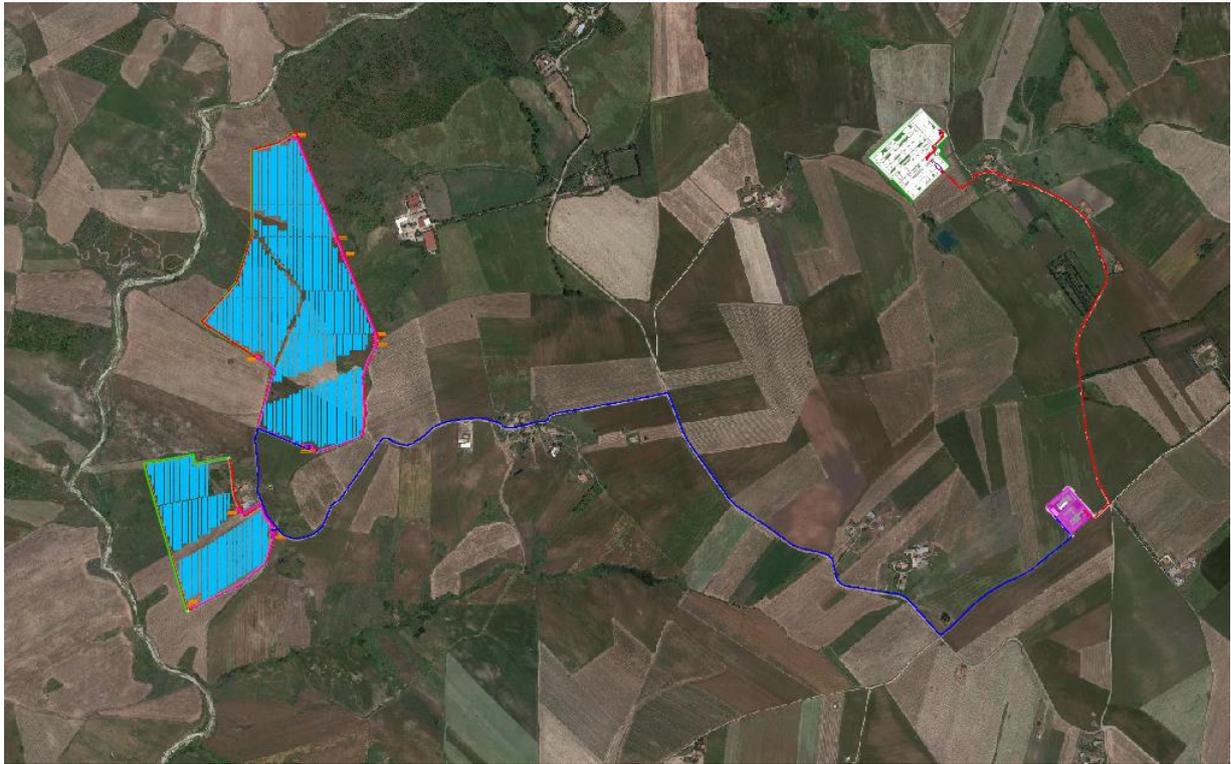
Stralcio elaborato DEF-TAV.04 – Layout su ortofoto
